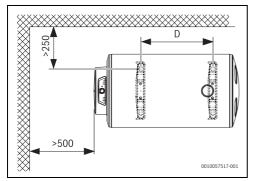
Dimensões em mm (montagem mural, instalação horizontal)
